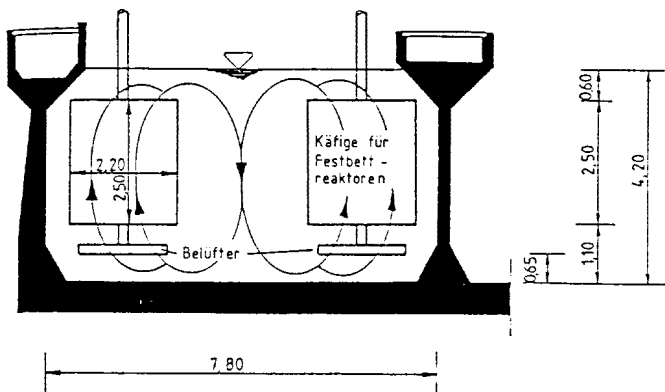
Einbauschema für die Ring-Lace Festbettreaktoren
